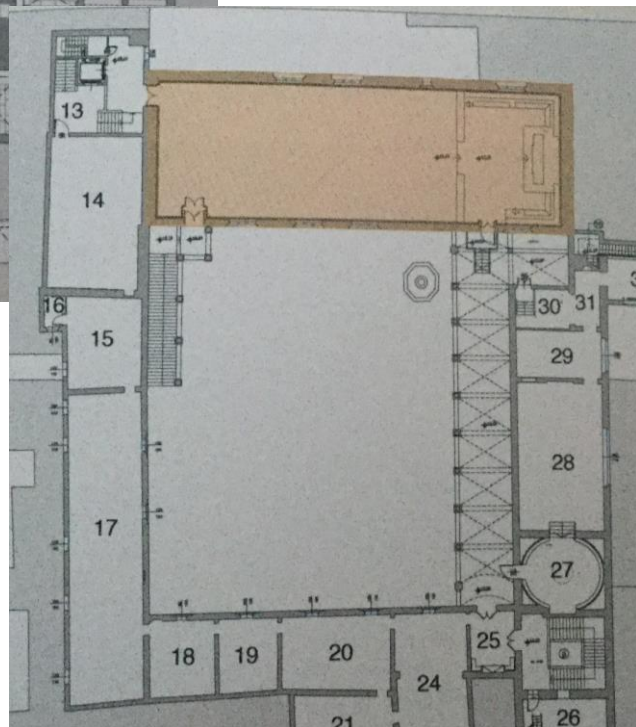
Planimetria del piano terreno del Palazzo Comunale di Novara.
